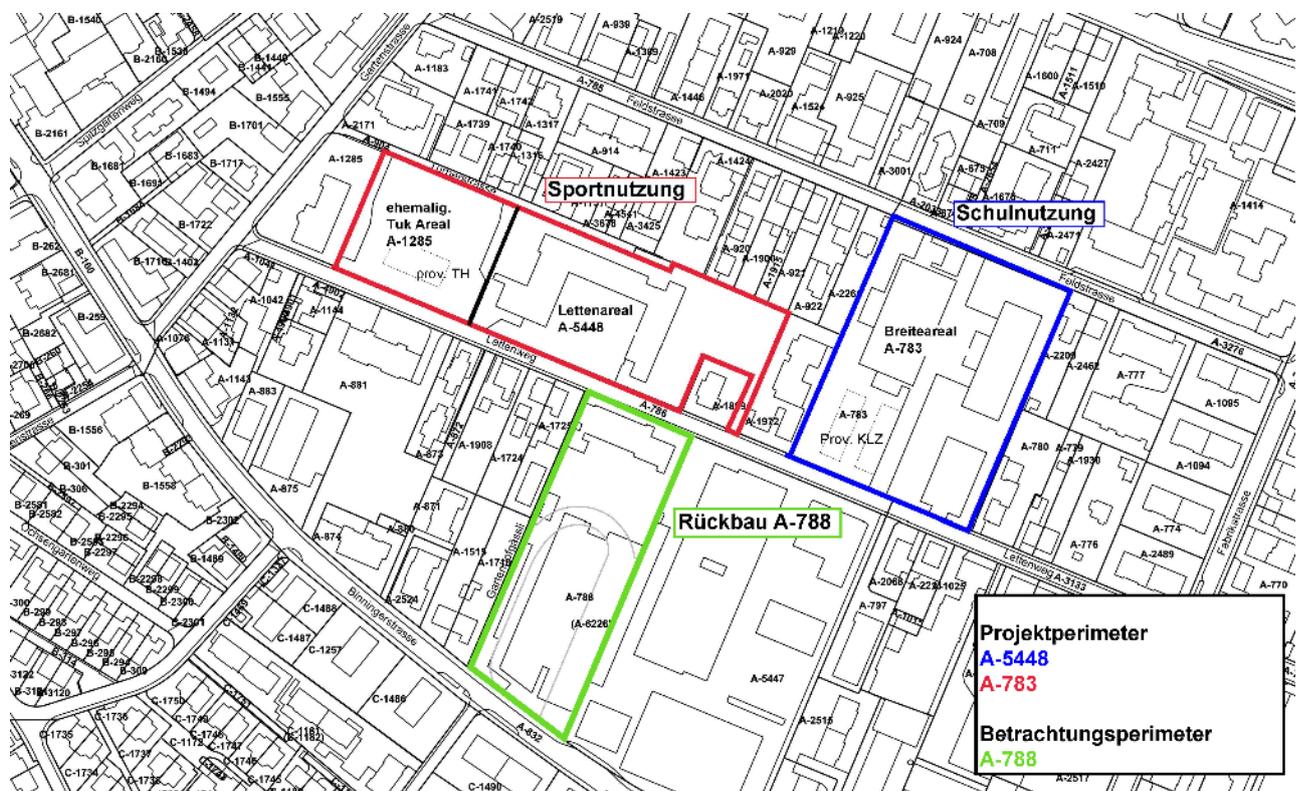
Situation Projekt- und Betrachtungsperimeter
